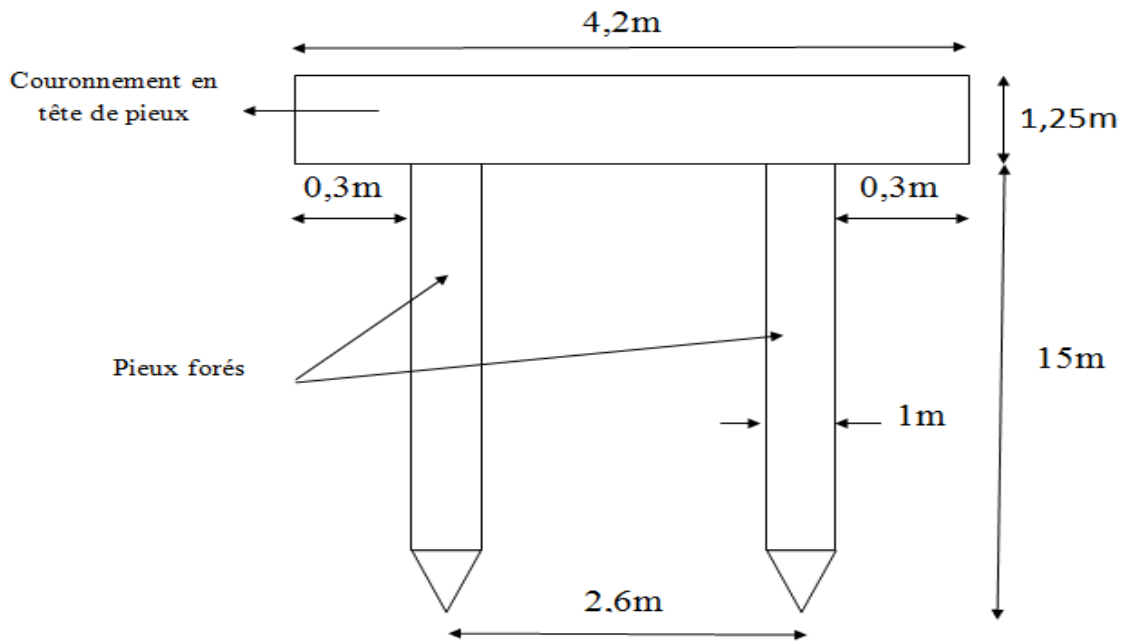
Détail d'exécution des pieux et de la poutre de couronnement.
